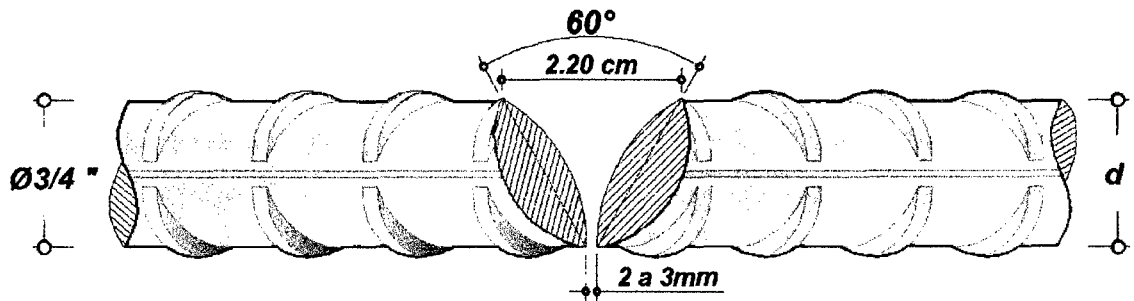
Detalle de corte en miembros de probeta para soldadura a tope directo con borde en “V” en barra de Ø 3/4”
